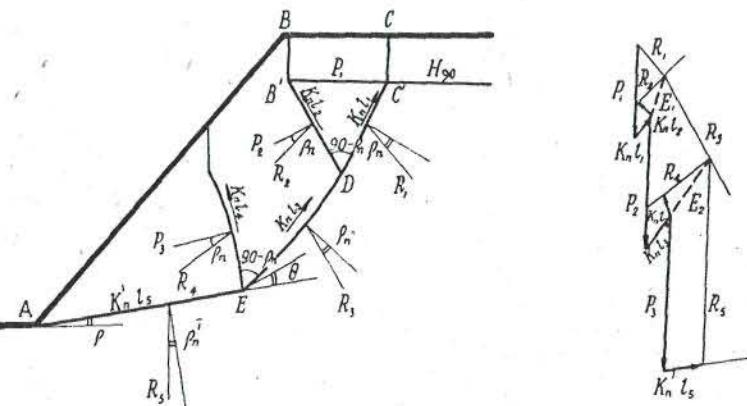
Схема к расчету устойчивости откоса методом многоугольника сил
